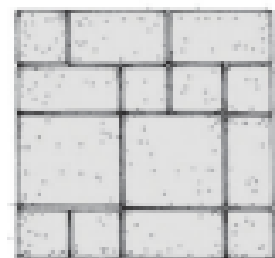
Diseño del pavimento de Adoquín. Fuente: PRECON
